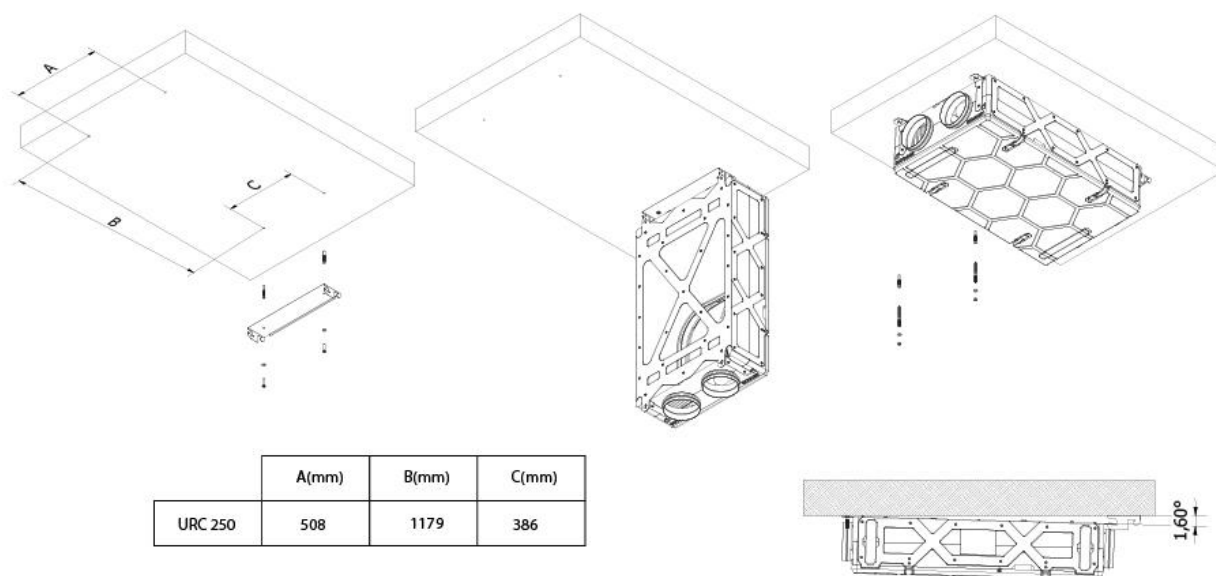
Unité suspendue horizontalement sur le cadre d'installation
